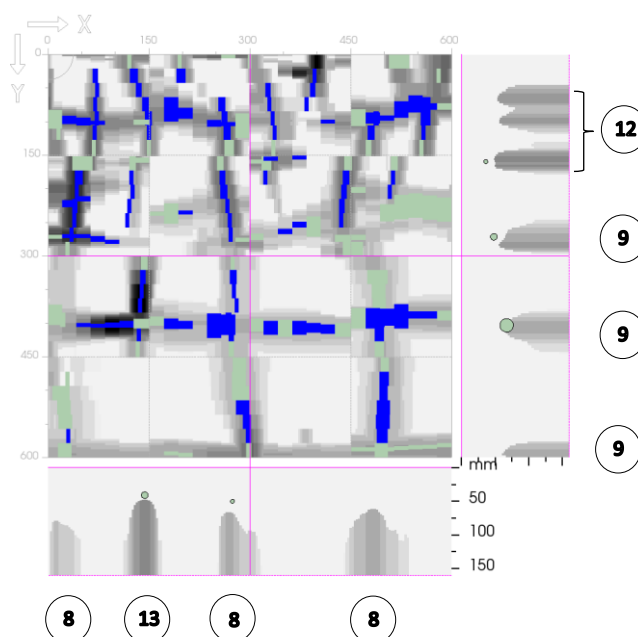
Ferrailage reconnu – Poutre Pt05
